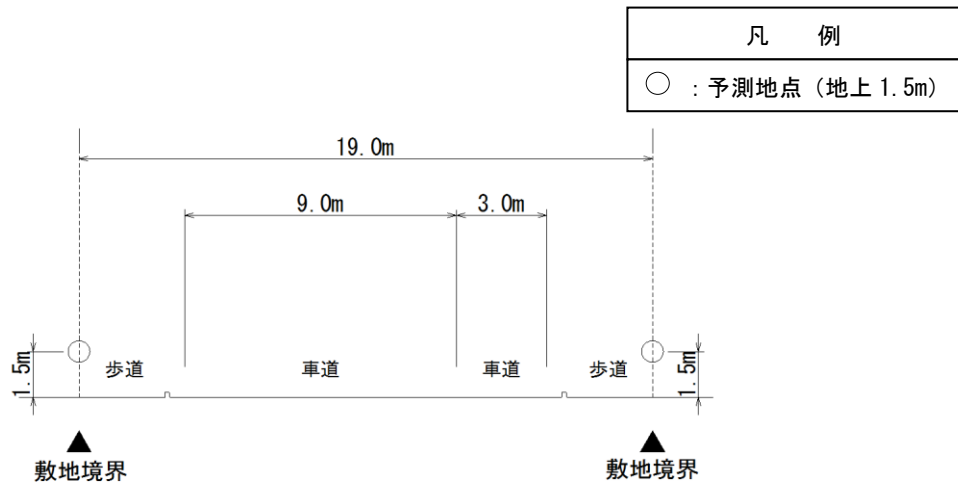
(5) 予測断面図 (E. 一般国道464号 (2))
